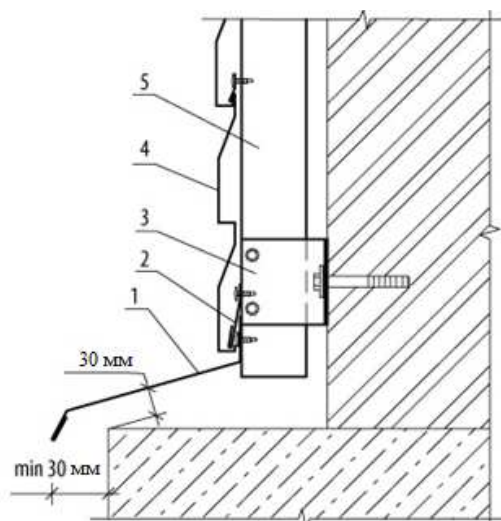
Крепление стартовой планки и отлива цоколя
